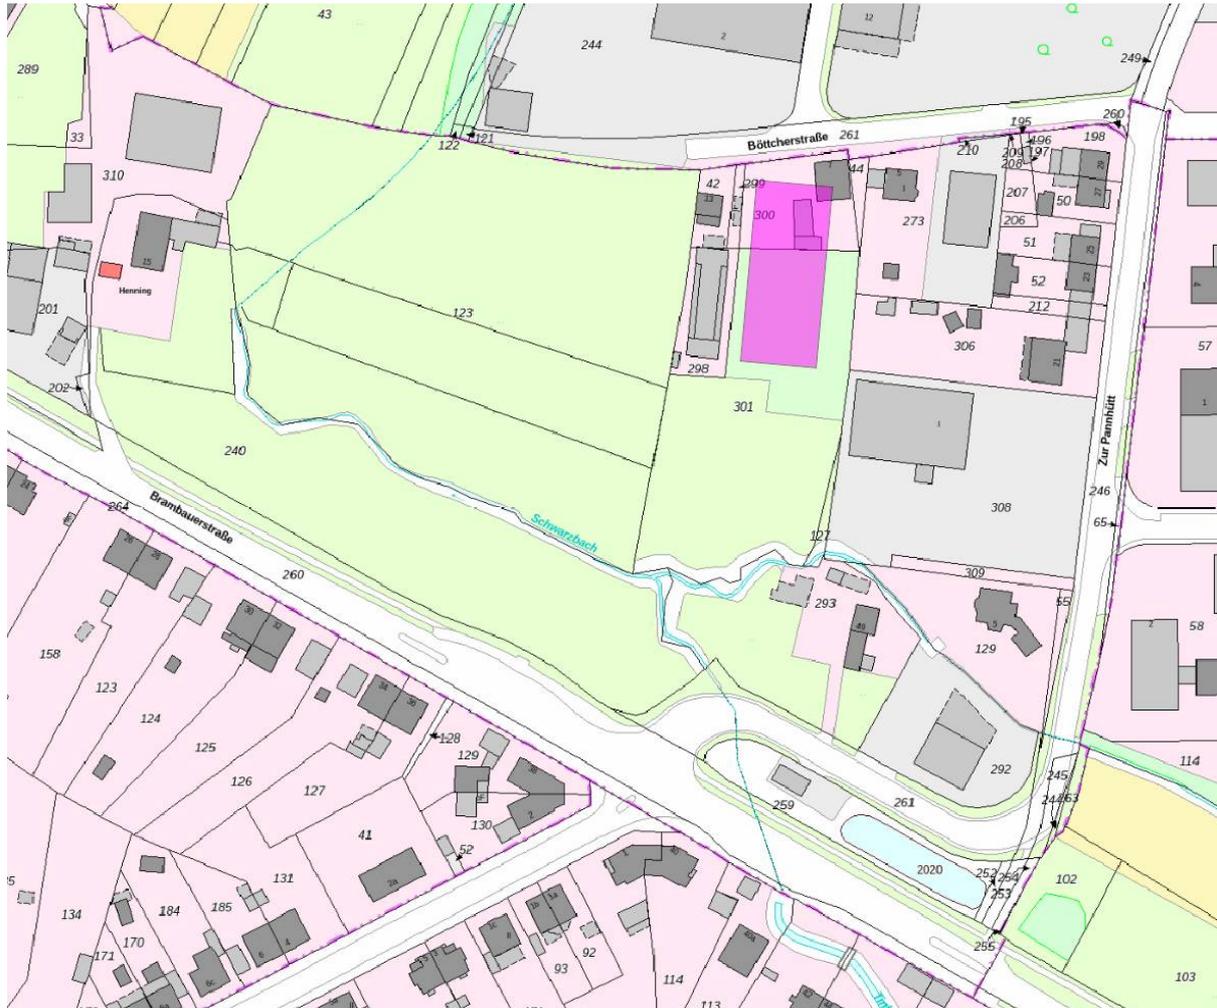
Lageplan mit den Flurstücken und den bisherigen Gebäuden, das Bau Feld für den Neubau ist in magenta markiert
